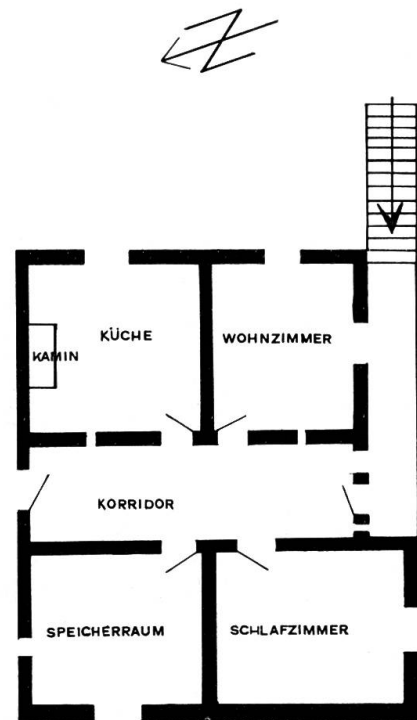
Haus Nr. 88. Obergeschoß. M 1:400
